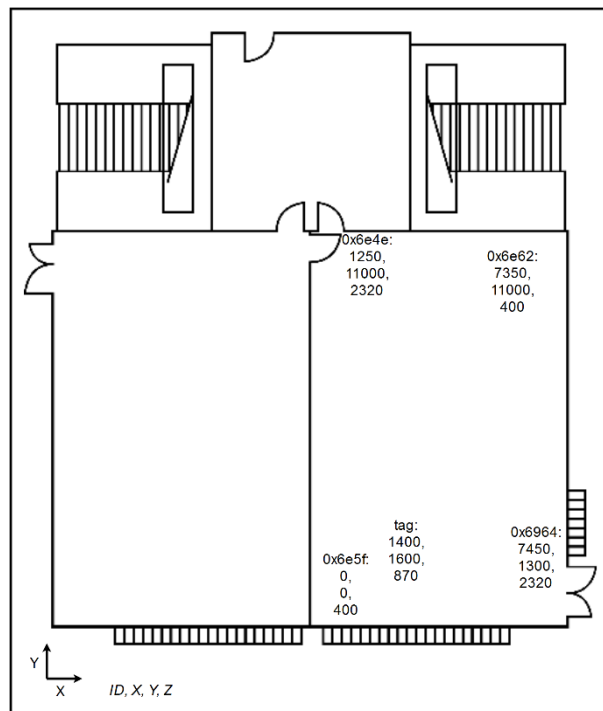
Grundriss des HSR Labors mit den Antennen des Positionierungssystems
